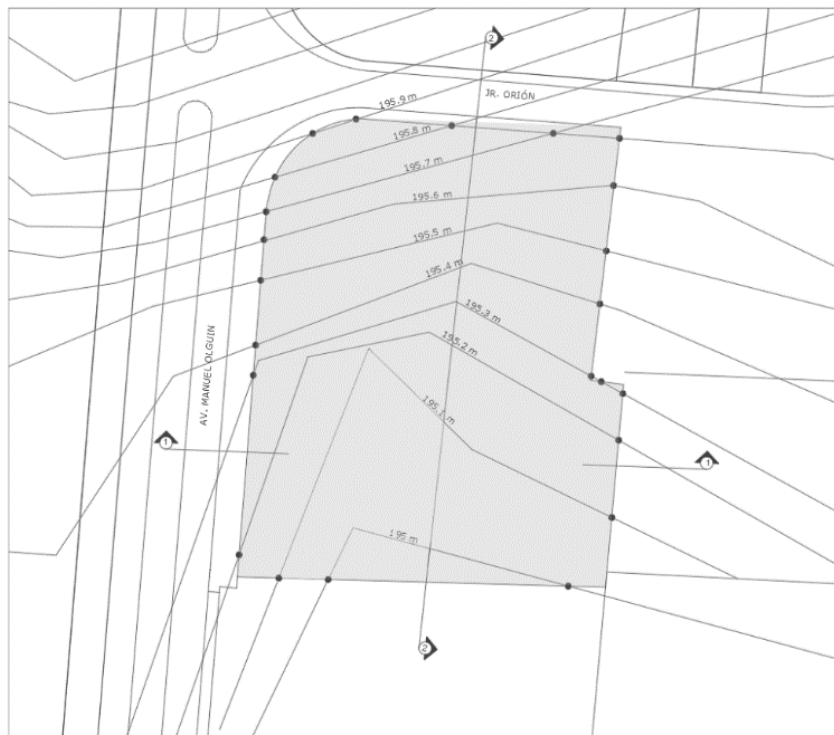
Plano topográfico del terreno. Fuente: Elaboración propia
